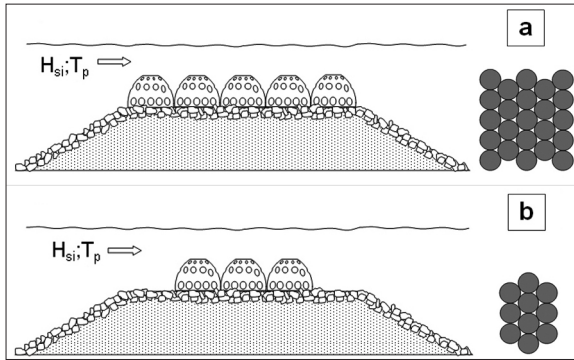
(a) *B-F1* in sezione (sx) ed in pianta (dx); (b) *B-P1* in sezione (sx) ed in pianta (dx).
